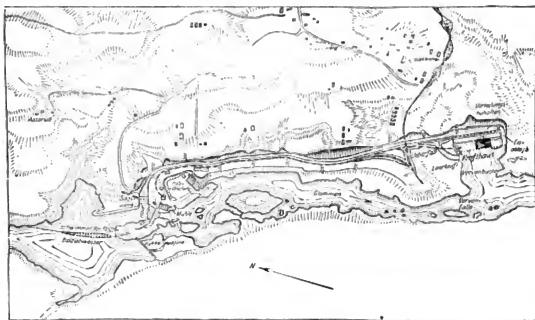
Lageplan der Wasserwerksanlage. — Massstab 1:10000.
